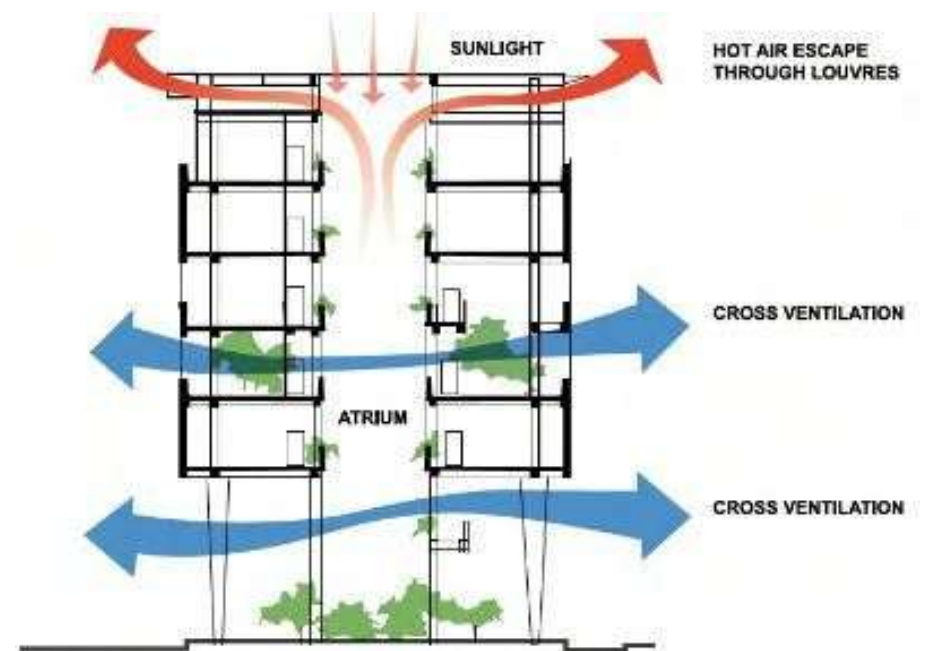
Penerapan Fasad Adaptif pada Bangunan
